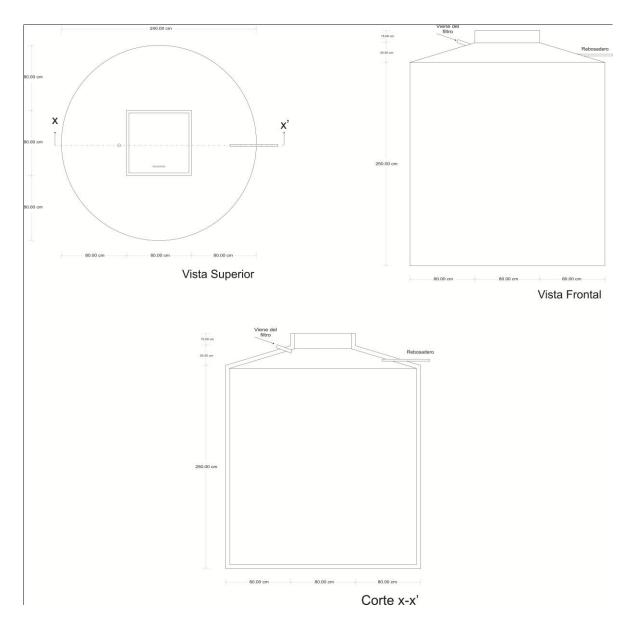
Plano del tanque de almacenamiento. (Planos detallados en el ANEXO)
